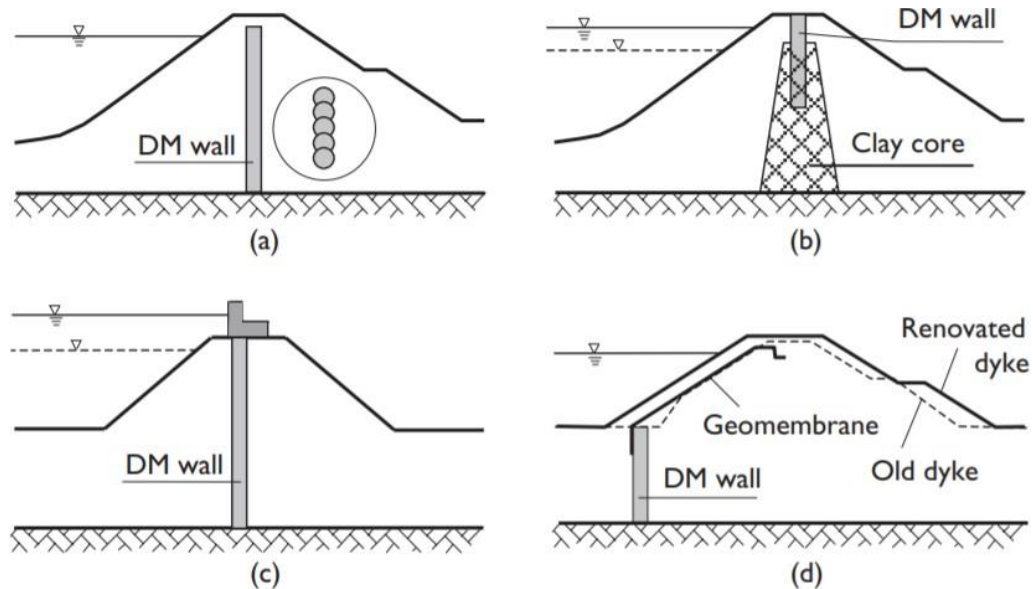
Algunos ejemplos de DSM para muros impermeables. a) barrera impermeable en embalse b) núcleo de arcilla c) dique con superestructura instalada encima d) protección de infiltraciones. [8]
